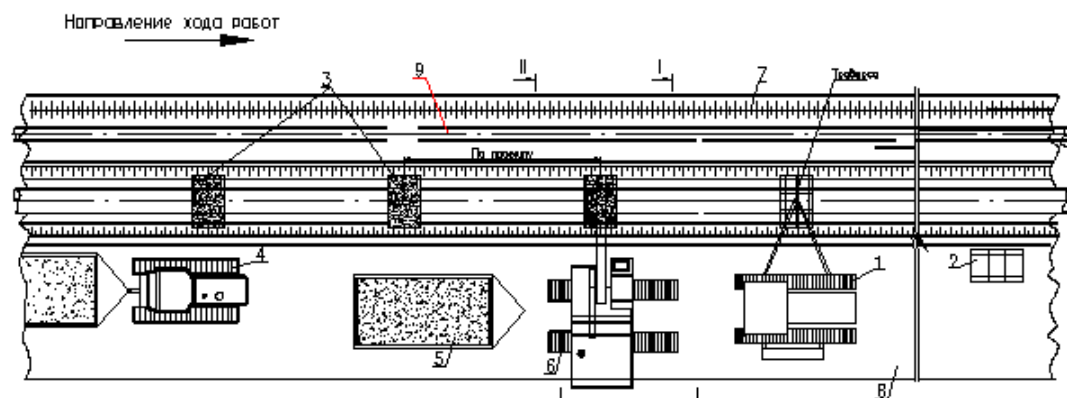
Схема организации работ по балластировке нефтепровода привозным грунтом
